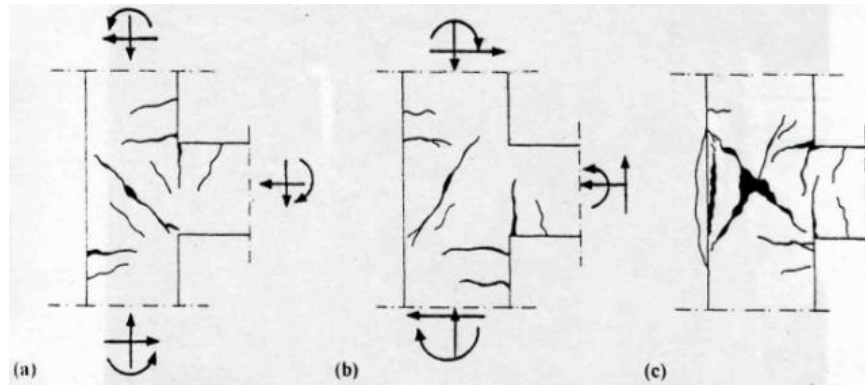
Processus de fissuration dans les nœuds de rive des planchers intermédiaires [2].
